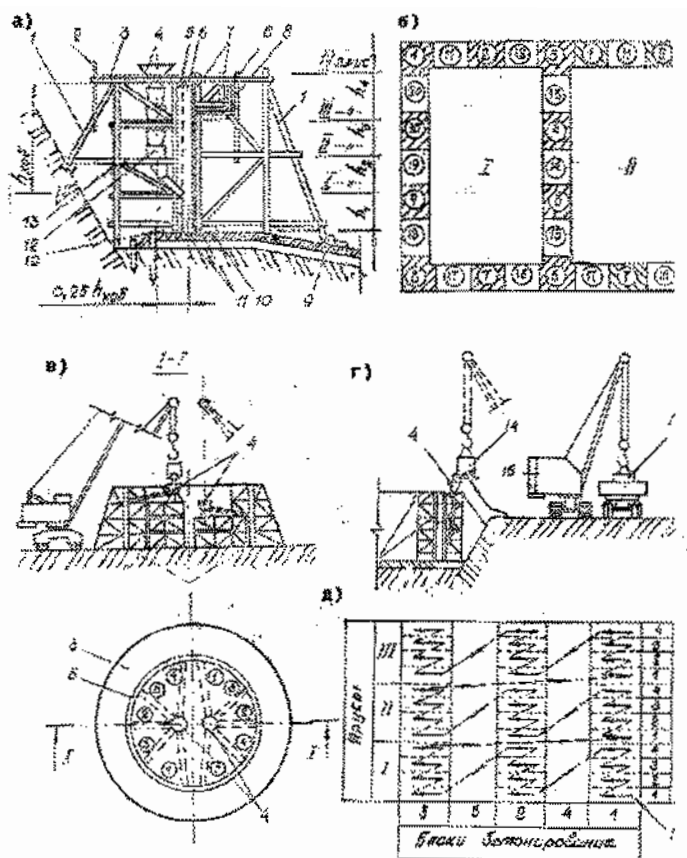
Бетонирование стен емкостных сооружений в щитовой опалубке: а - общая схема бетонирования стены и разбивка ее на ярусы; б - разбивка стен на захватки (римские цифры) и блоки бетонирования (арабские цифры); в, г - подача бетонной смеси бадьями с помощью крана; д - последовательность установки опалубки и укладки бетона; 1 - подкос; 2 - ограждение; 3 - рабочий настил; 4 - приемный бункер; 5 - границы щитов опалубки; 6 - бетонизируемые конструкции; 7, 8 - опалубка лотка и ее каркас; 9 - упор; 10 - прижимная доска; 11 - ребра жесткости; 12 - хобот звеньевой; 13 - опора подмостей; 14 - вибробадья; 15 - кран; цифрами в кружках указана последовательность бетонирования стен;  $h_1 - h_4$  - высоты ярусов
